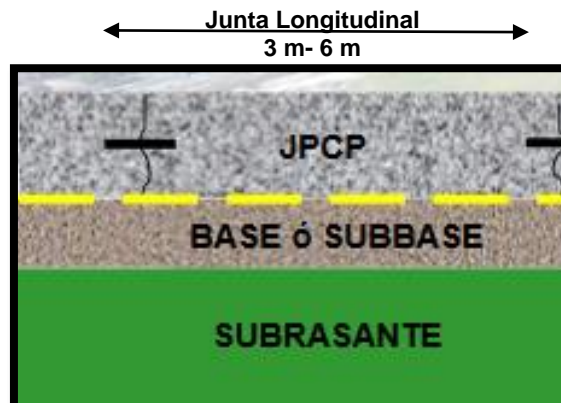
Pavimento de Concreto Simple con Dovela (JPCP)
